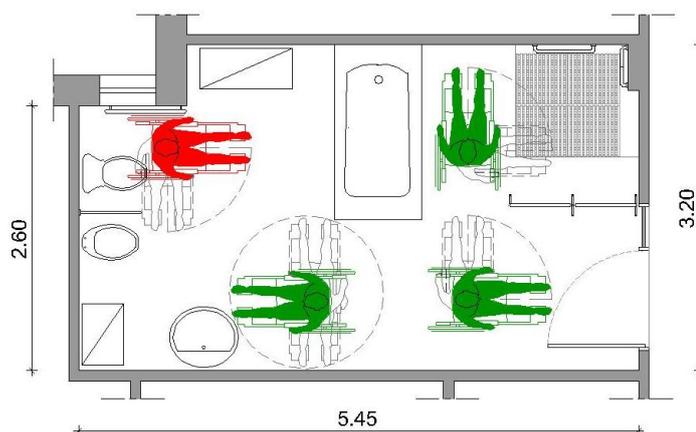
ILPI 1 -1º pavimento - Planta baixa banho assistido.
